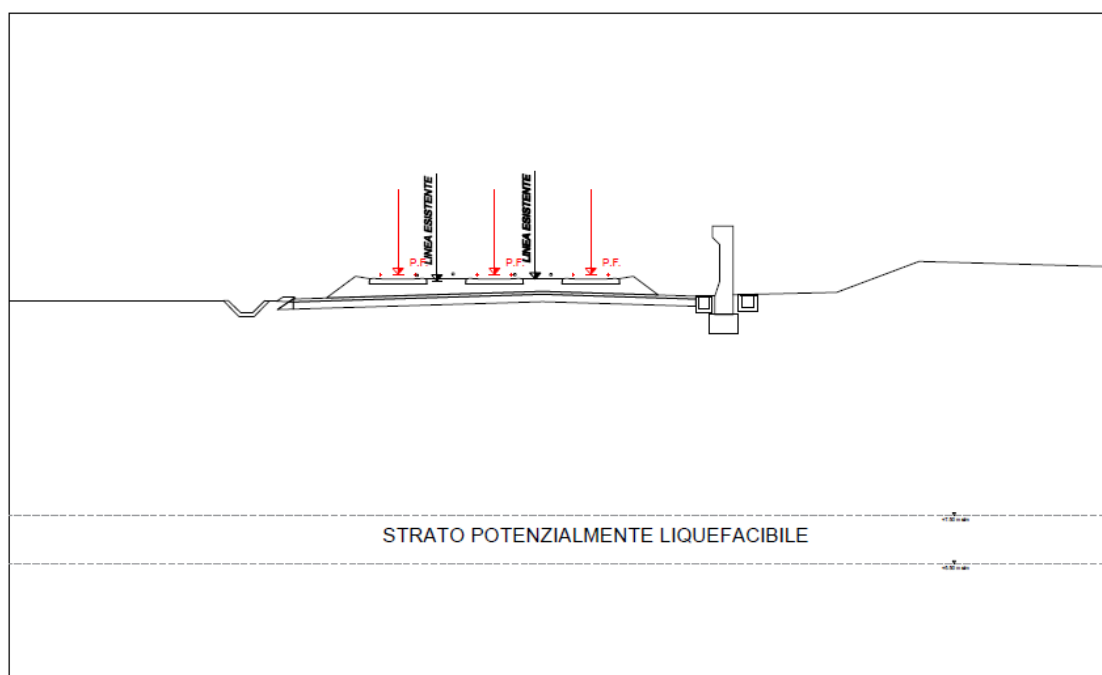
Sezione rilevato alla pk 5+050 su strato di terreno liquefacibile
